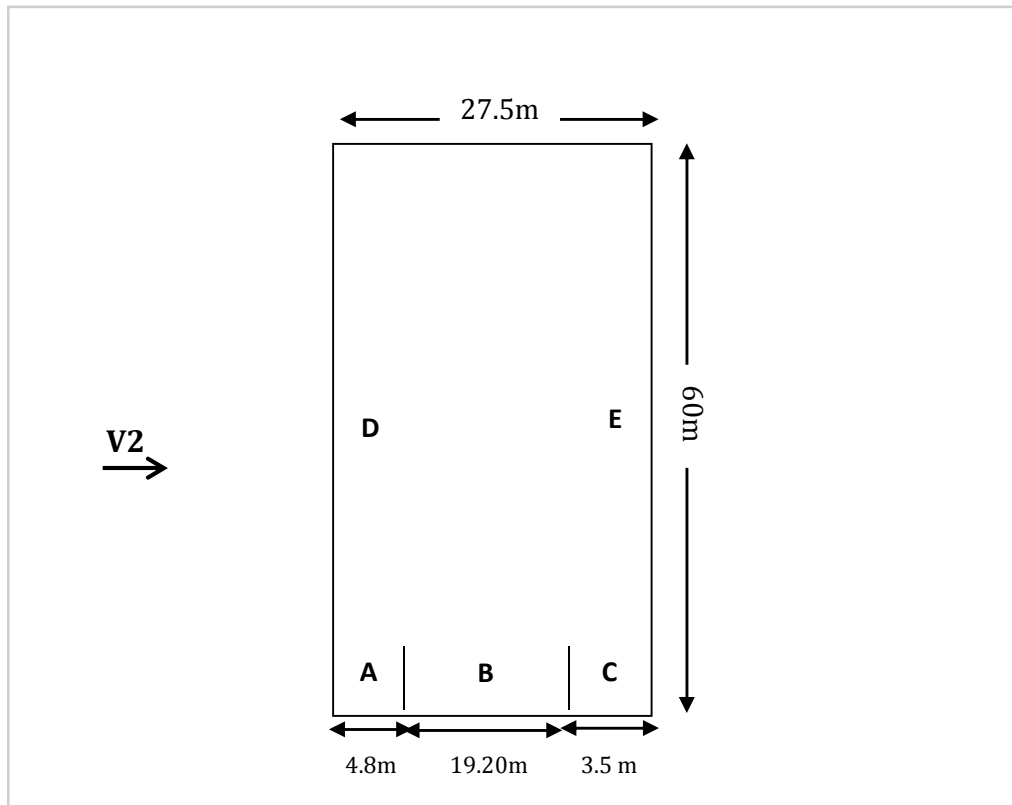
vue en plan des zones de pression sur les parois verticales sens V2.
